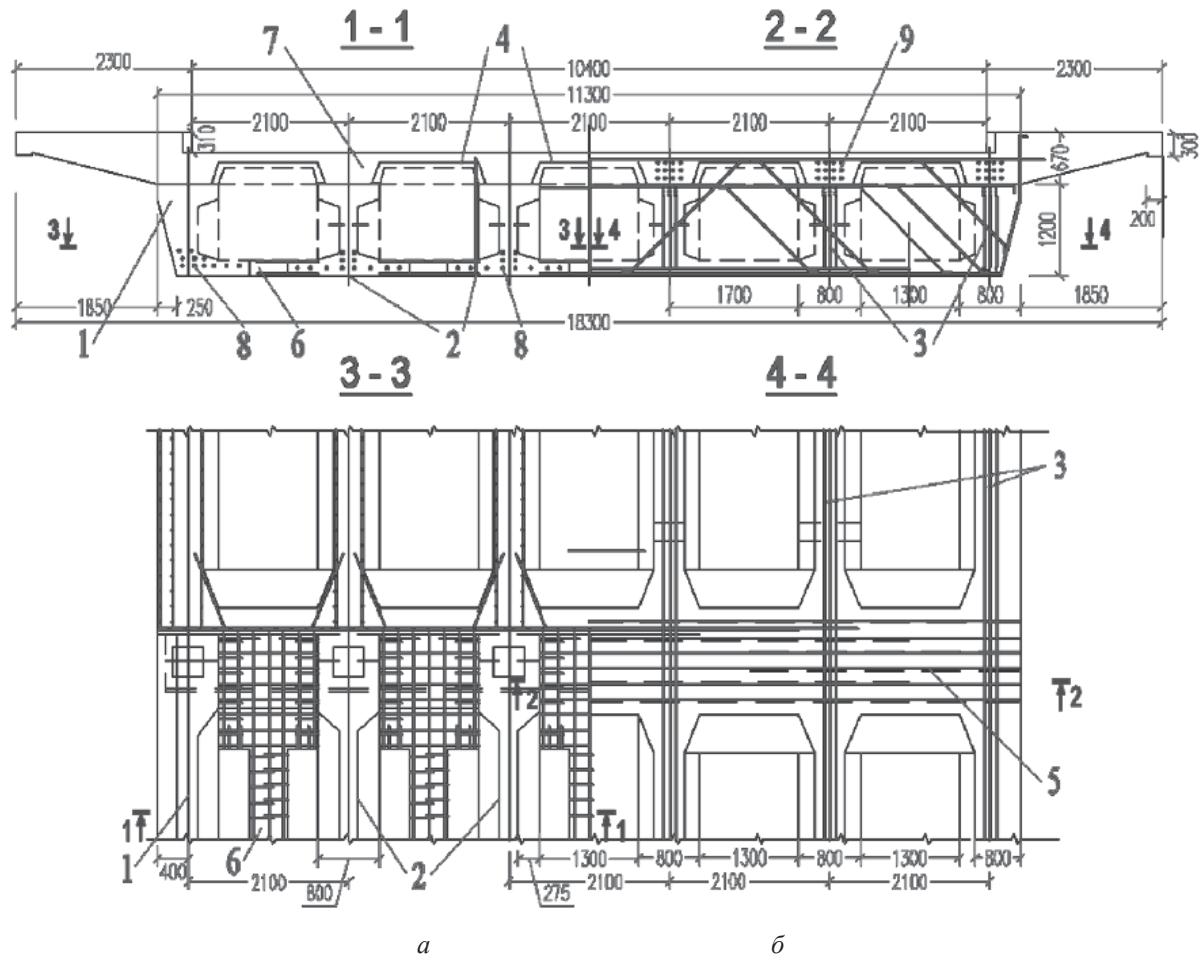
Фрагмент плану і перерізів прогонової будови:
